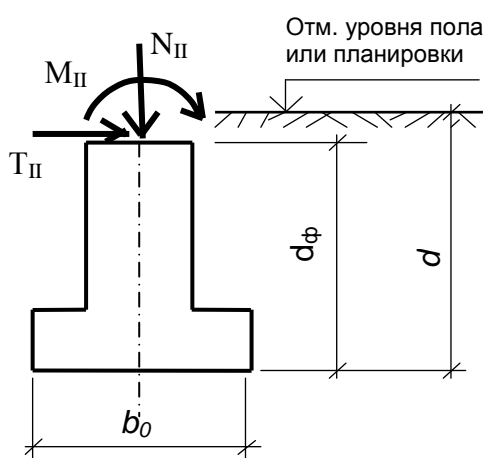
Предварительная расчетная схема фундамента на естественном основании
